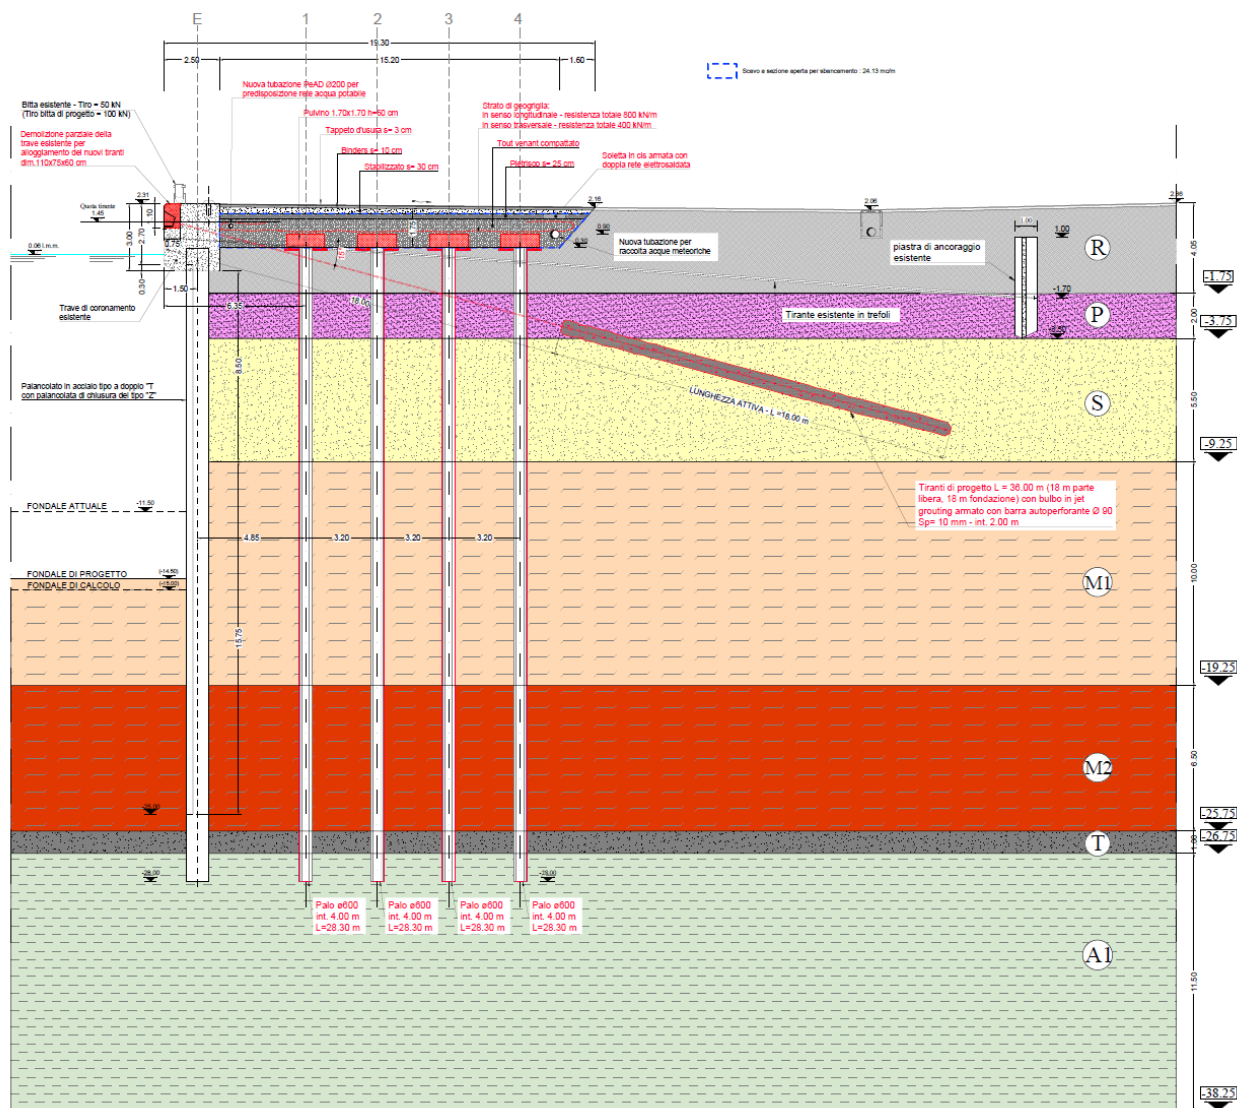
Sezione tipologica intervento da progetto esecutivo
